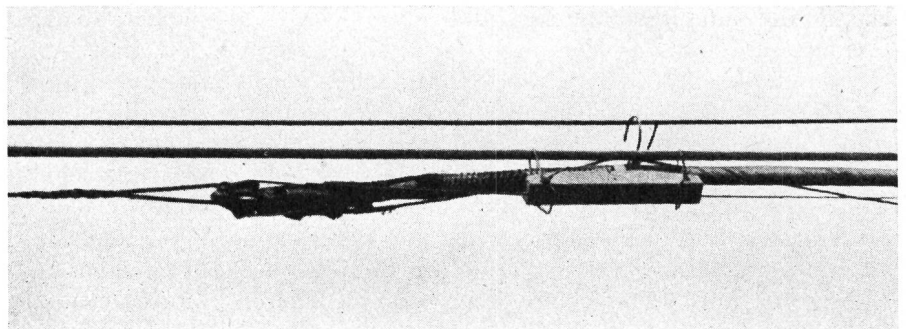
Befestigung des Kabels vom Montagewagen aus
